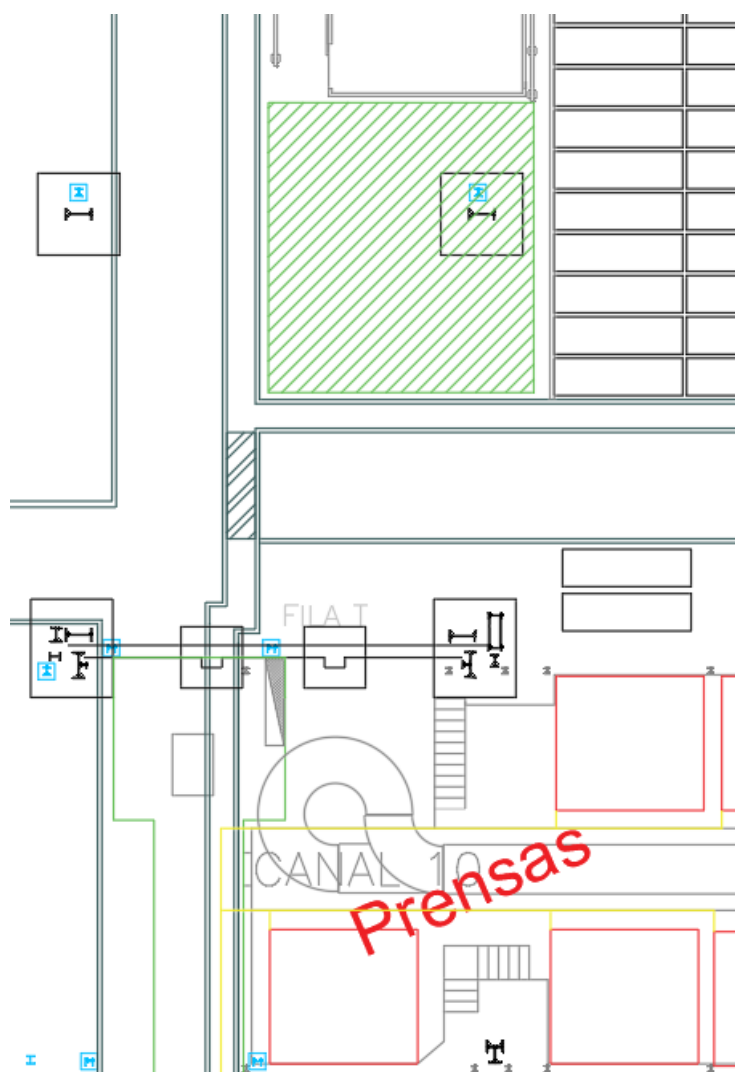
Planta da Região de instalação: área hachurada a destinada a conexões entre piso inferior e superior próximo ao corredor de prensas.
